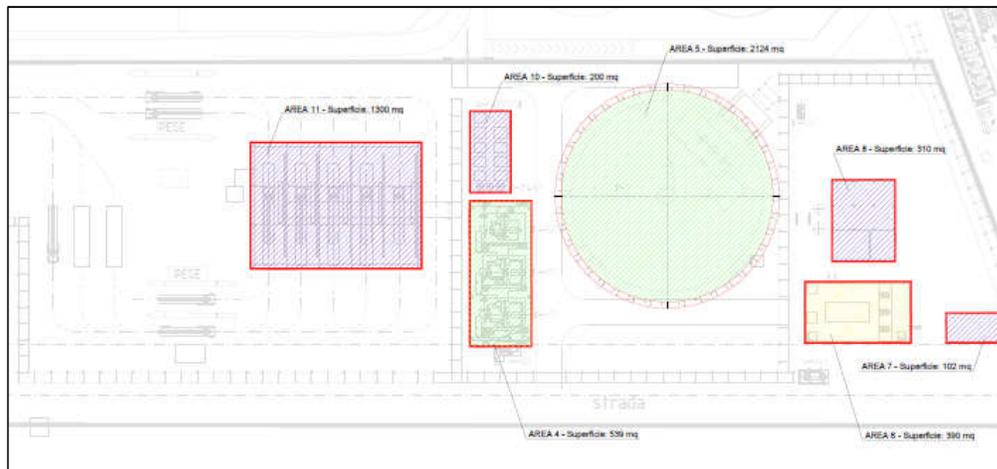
Planimetria delle Aree di Scavo a Sezione Obbligatoria per l'Area Nord dell'Impianto
